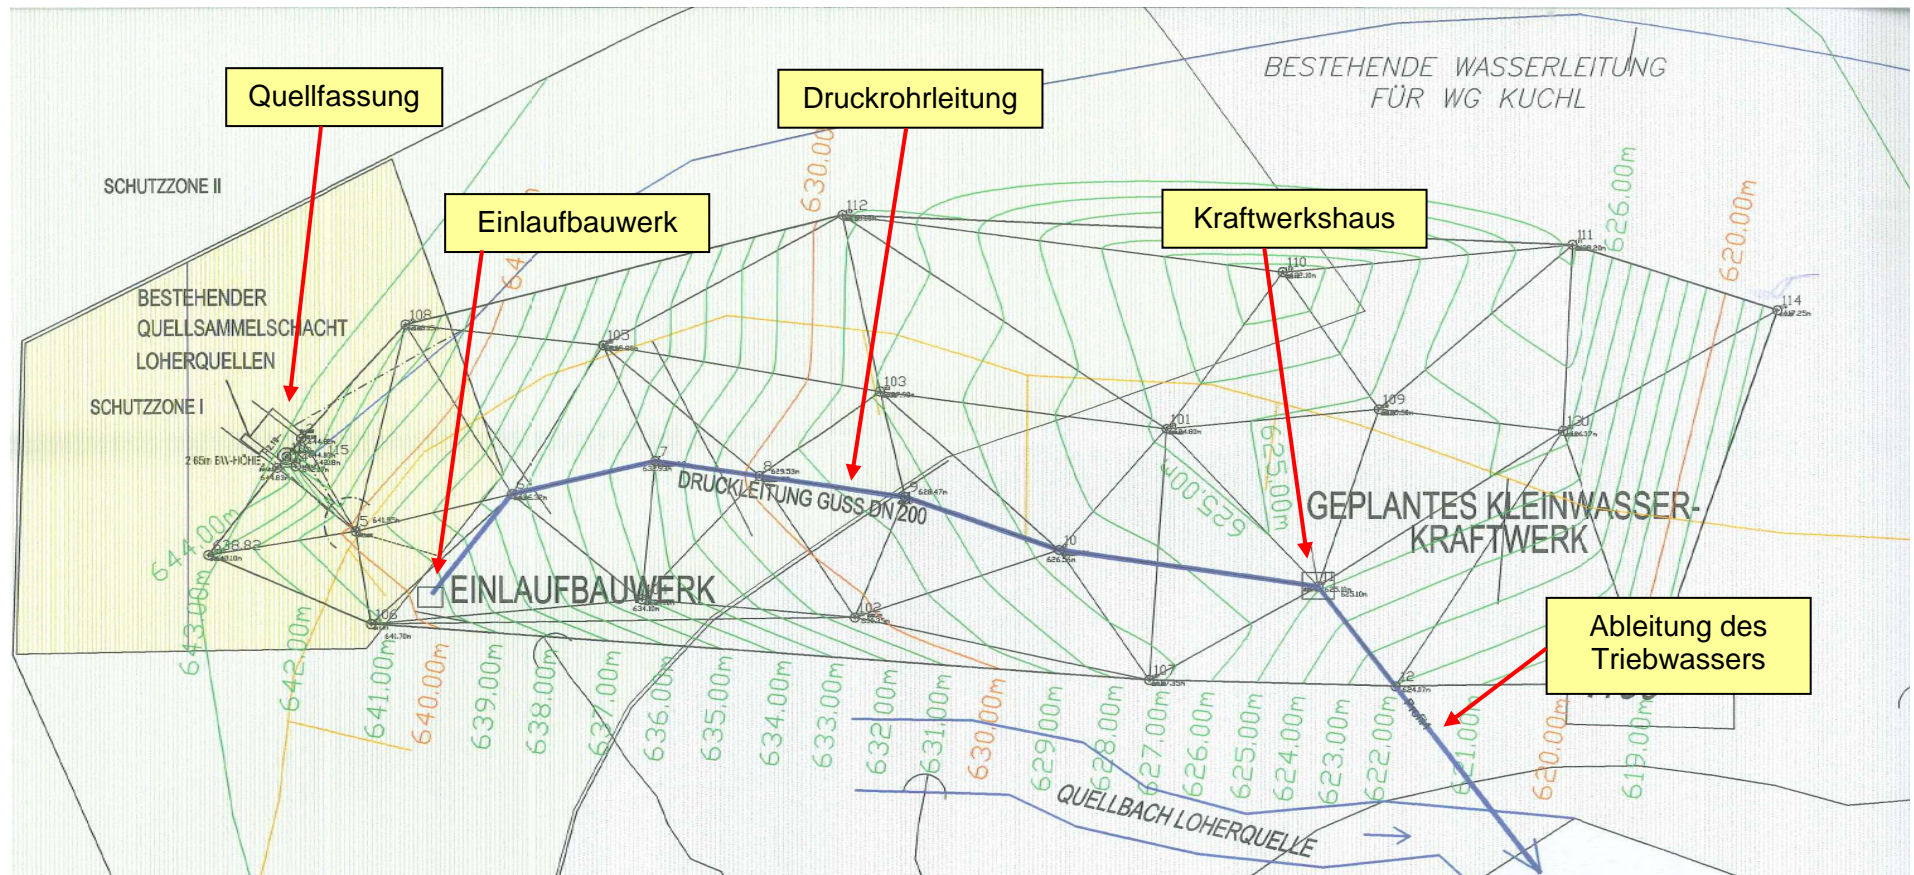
Detaillageplan Kleinkraftwerk, Fa. ISF Julius Welser Str. 15 A-5020 Salzburg, Projektplannummer 102, Ausfertigung B, vom 04.08.2010.
